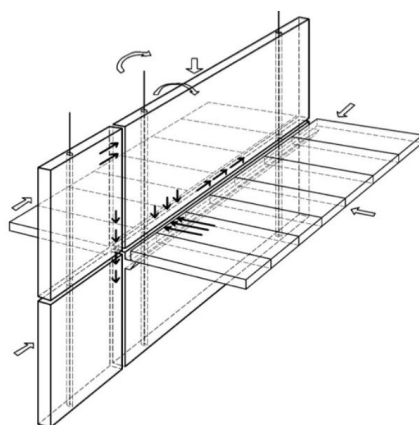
Ações nas ligações horizontais e verticais entre elementos de parede, adaptado de [9].
